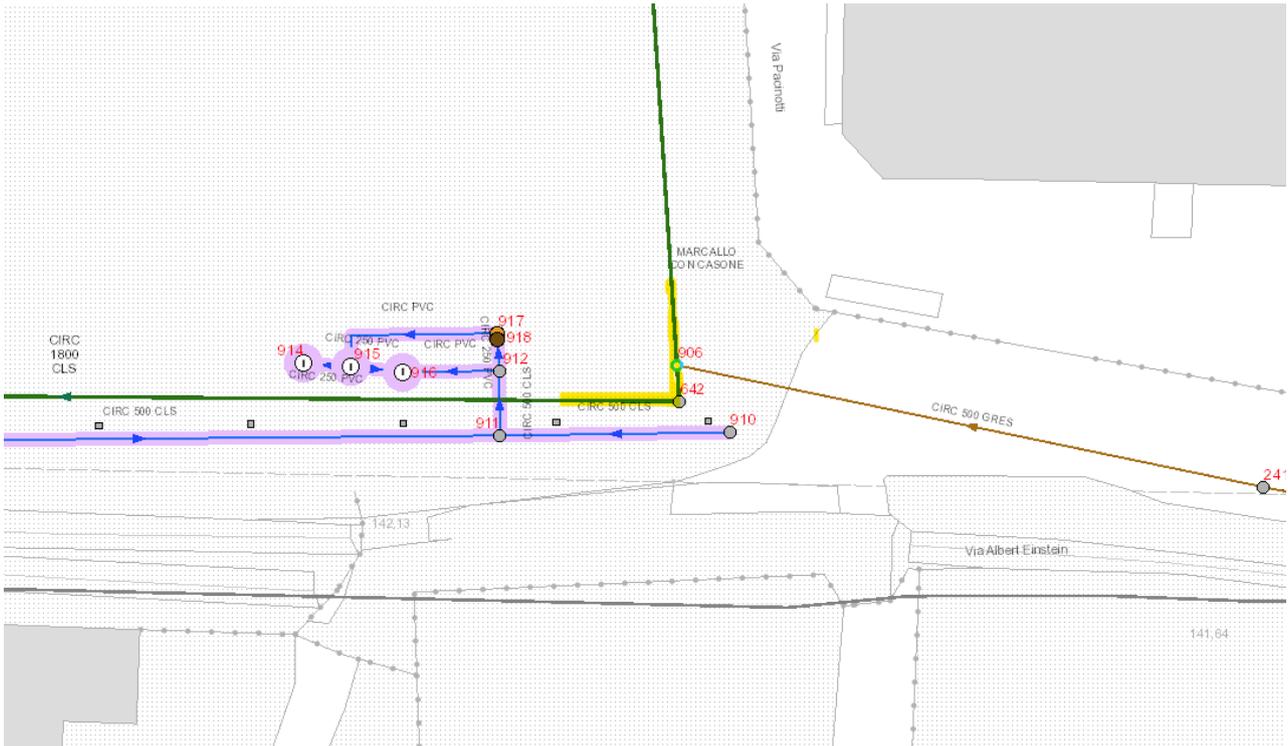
Planimetria rete fognaria - stato di fatto
